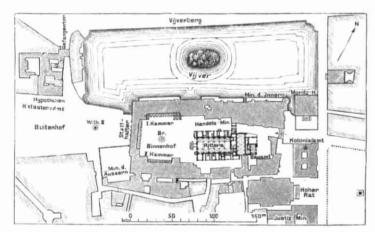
Binnenhof. Lageplan und Grundriß im Jahre 1891.
